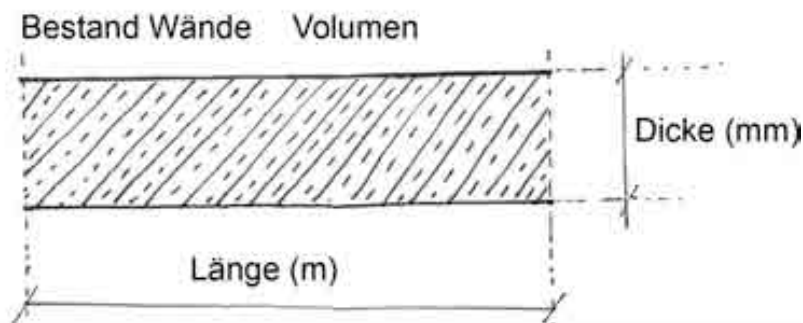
Bauteil, Vertikale Elemente , Gründung Bestand Beton Wand
